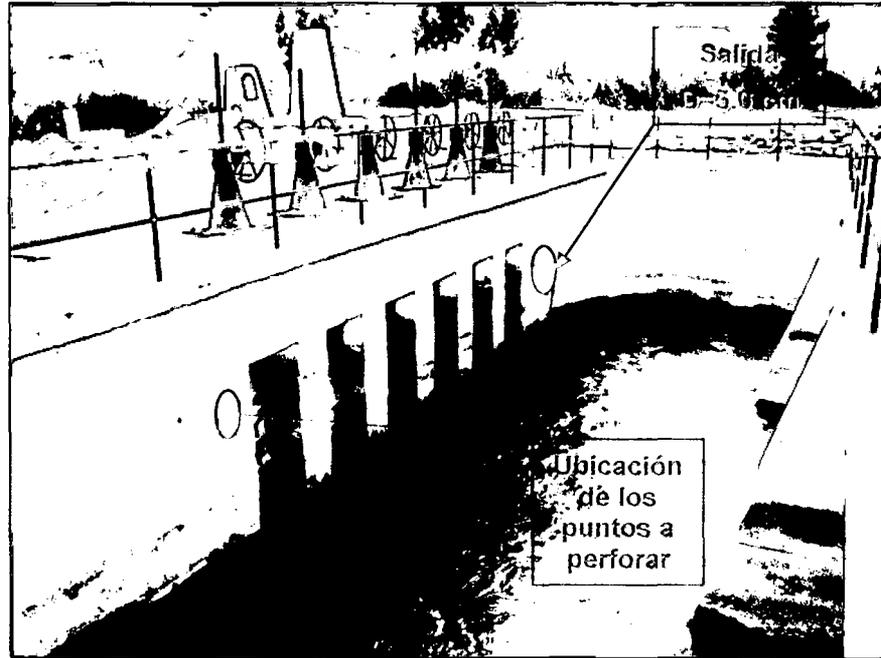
Vista de la entrada de las compuertas de captación
